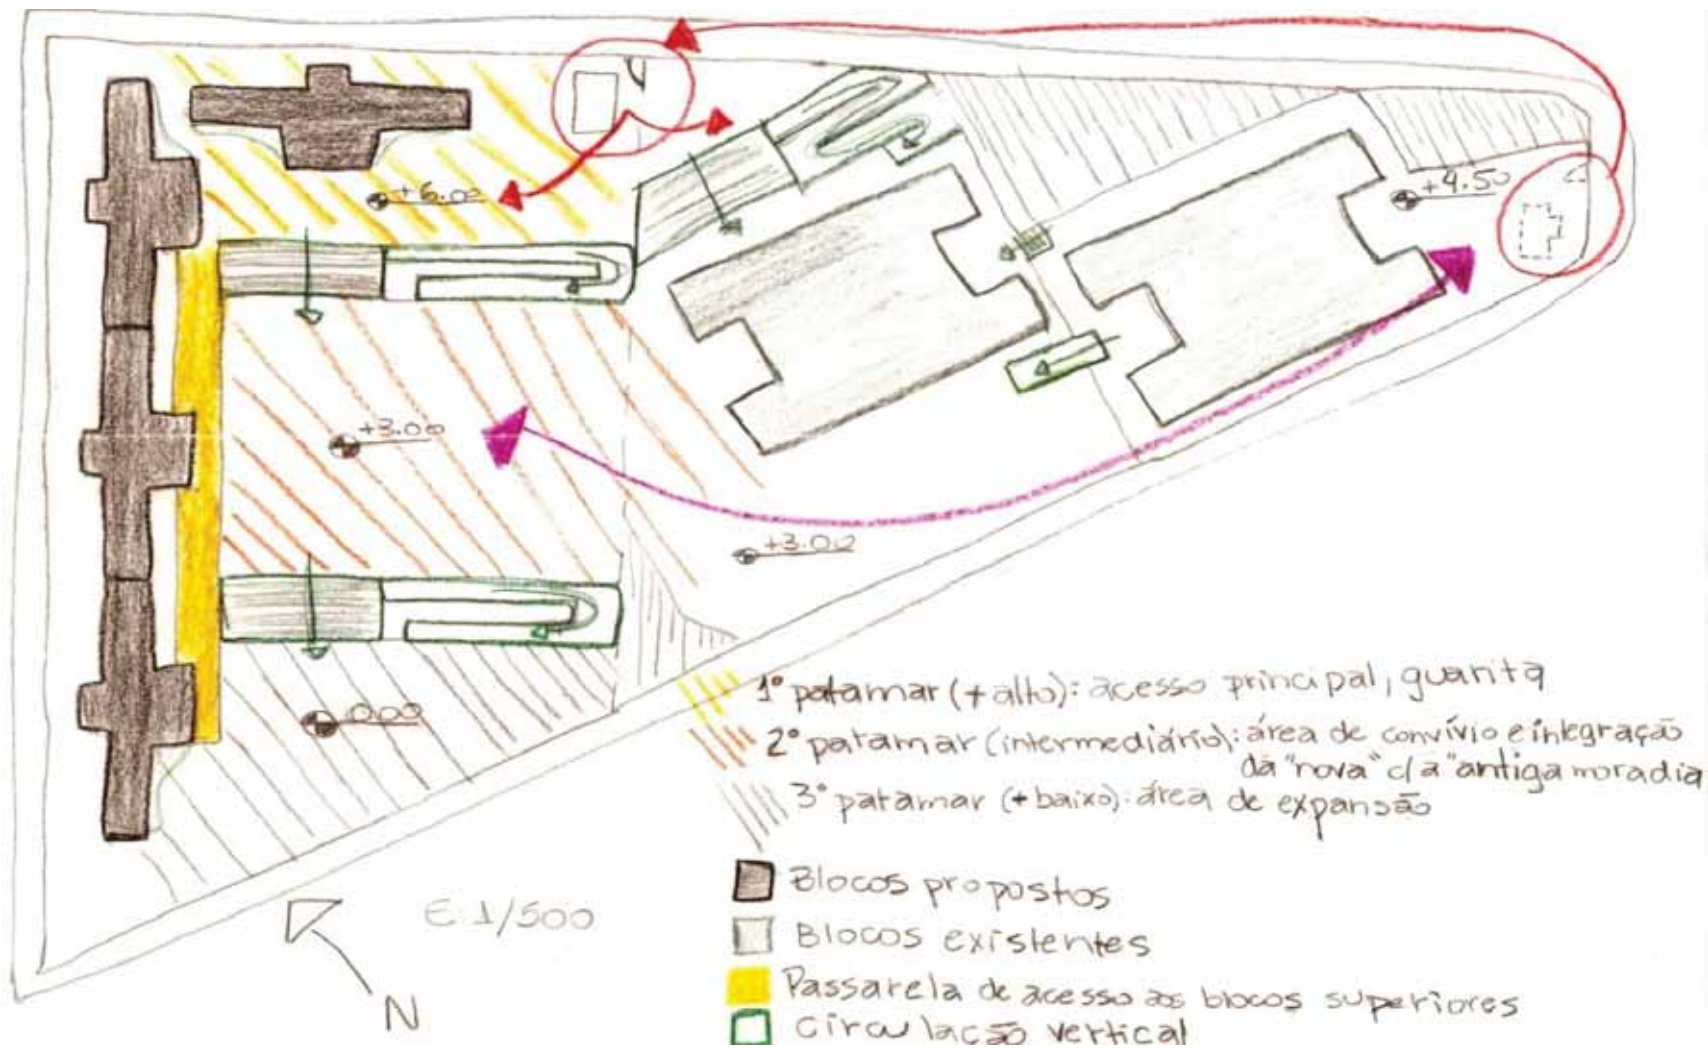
Croqui da primeira proposta de implantação com plano de massas. Fonte: FERRO, 2011.
